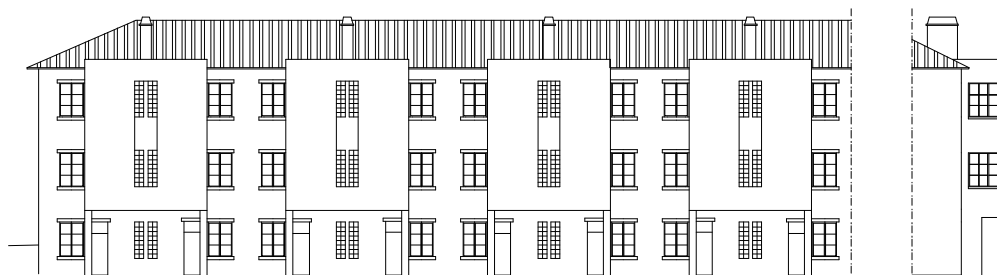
Alçados posterior e lateral (parciais) do conjunto – Proposta de Alterações
